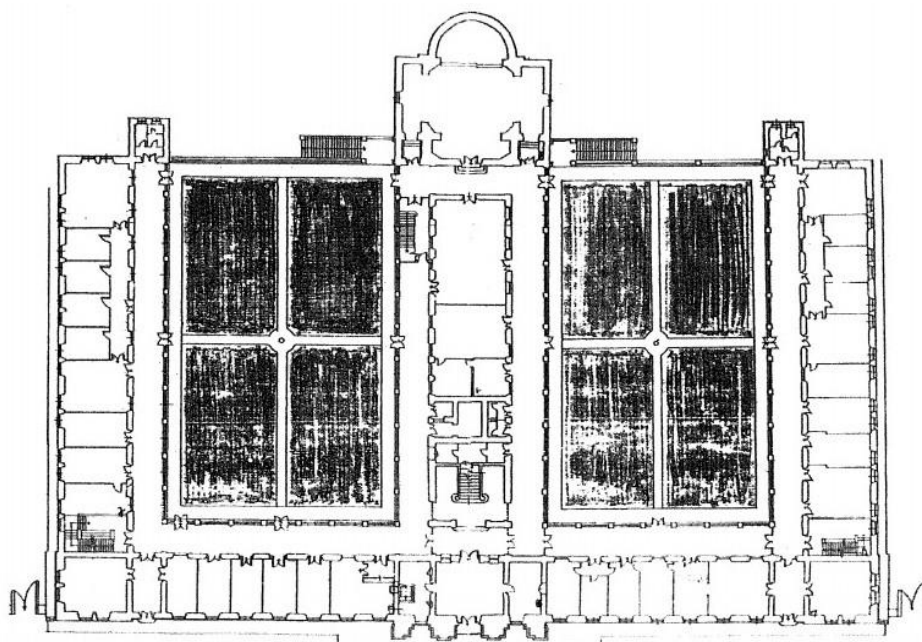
Plano de la planta baja del palacio, dónde se situaban las aulas del instituto
